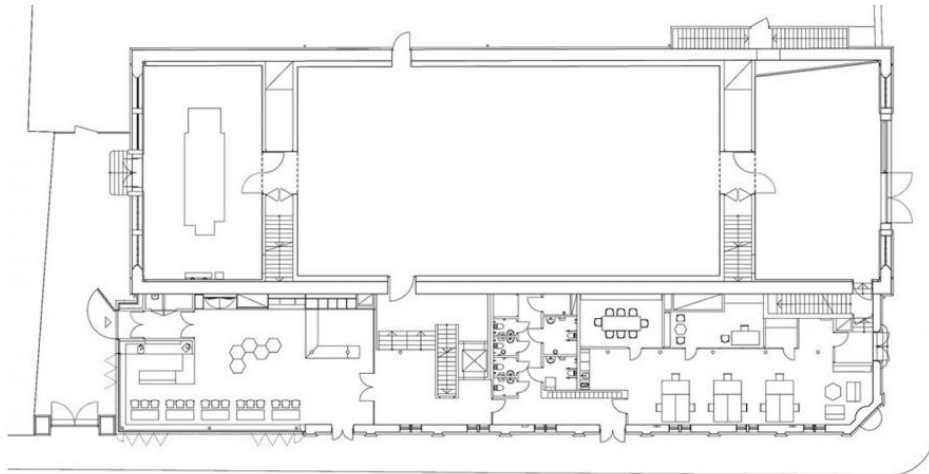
Planta do piso 0. Moderna Museet Malmö.
